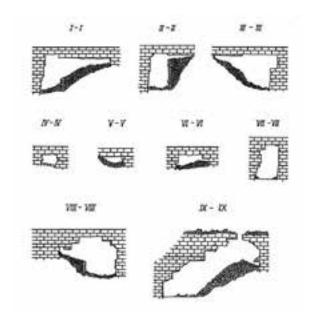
Сечения к плану каменоломни Покрово-Казацкая-1а
